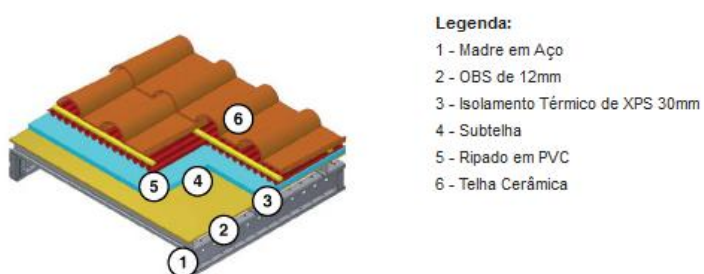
Pormenor construtivo de uma cobertura inclinada (TÉKETO, 2010)
